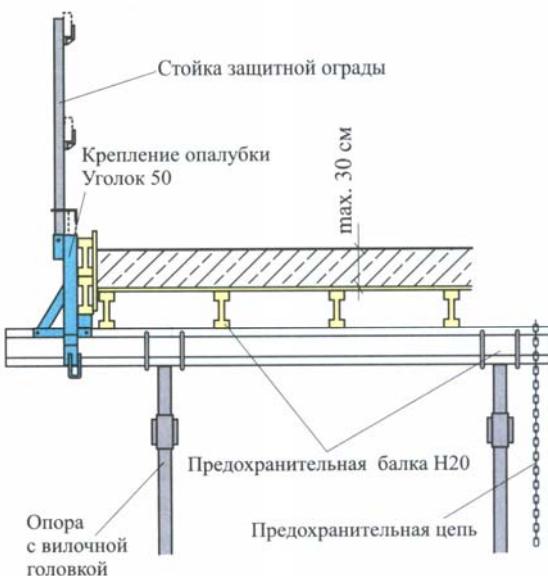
Опалубка перекрытий фирмы «НОЕ» с балками H20:
